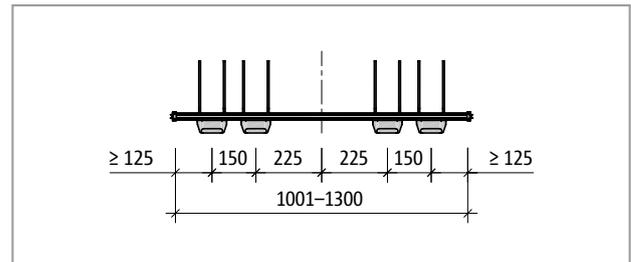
Schöck Tronsole® Typ T-V4-...-L1001 bis L1300: Produktgrundriss
